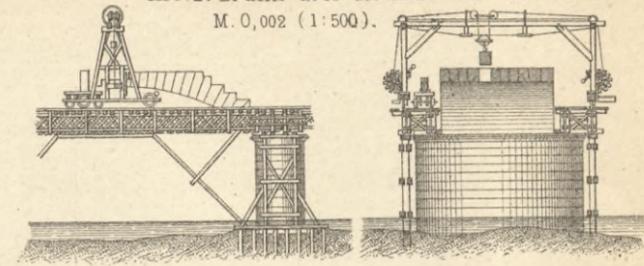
^b-3^d. Gerüst für den Pfeilerbau.
